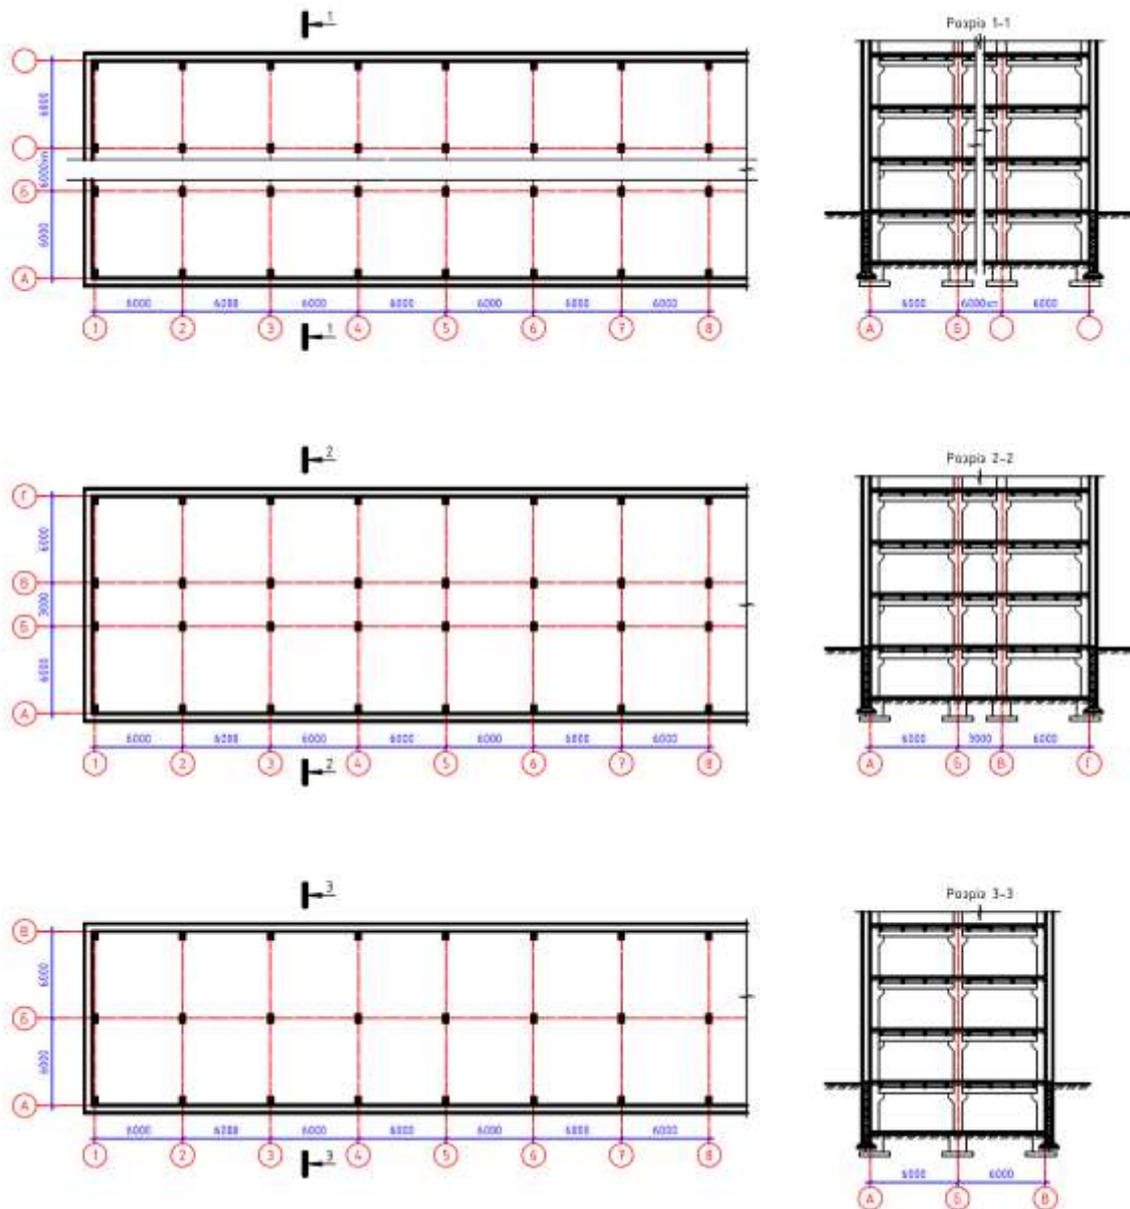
Об’ємно-планувальні схеми сховищ промислових будівель
